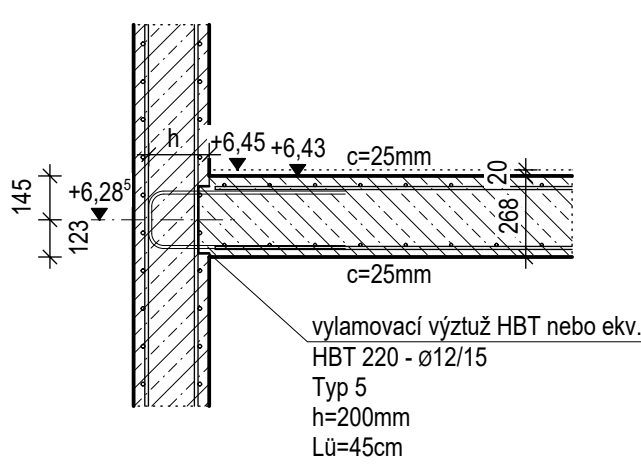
DETAILY NAPOJENÍ VÝZTUŽE M 1:25
